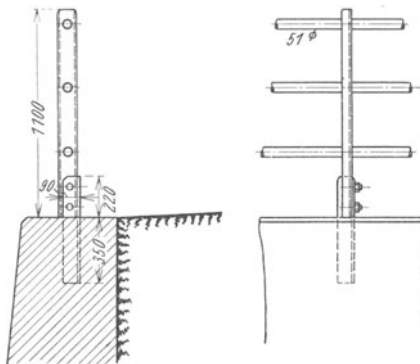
Geländer mit abnehmbaren Ständern für lawinengefährdete Strecken.
